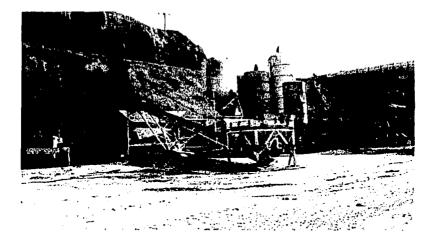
Fotografía de planta de concreto instalada en el Portal.
